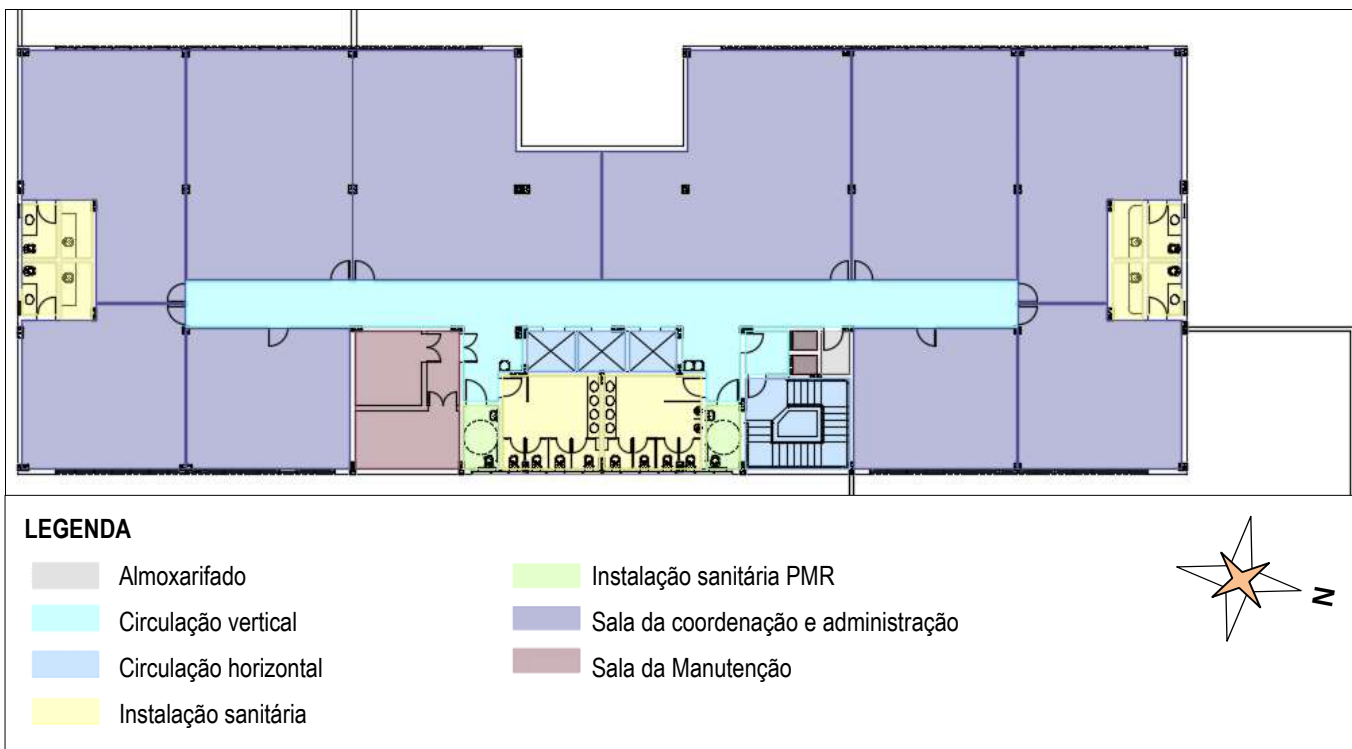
Planta setORIZADA do primeiro ao quarto pavimento do bloco 02.
